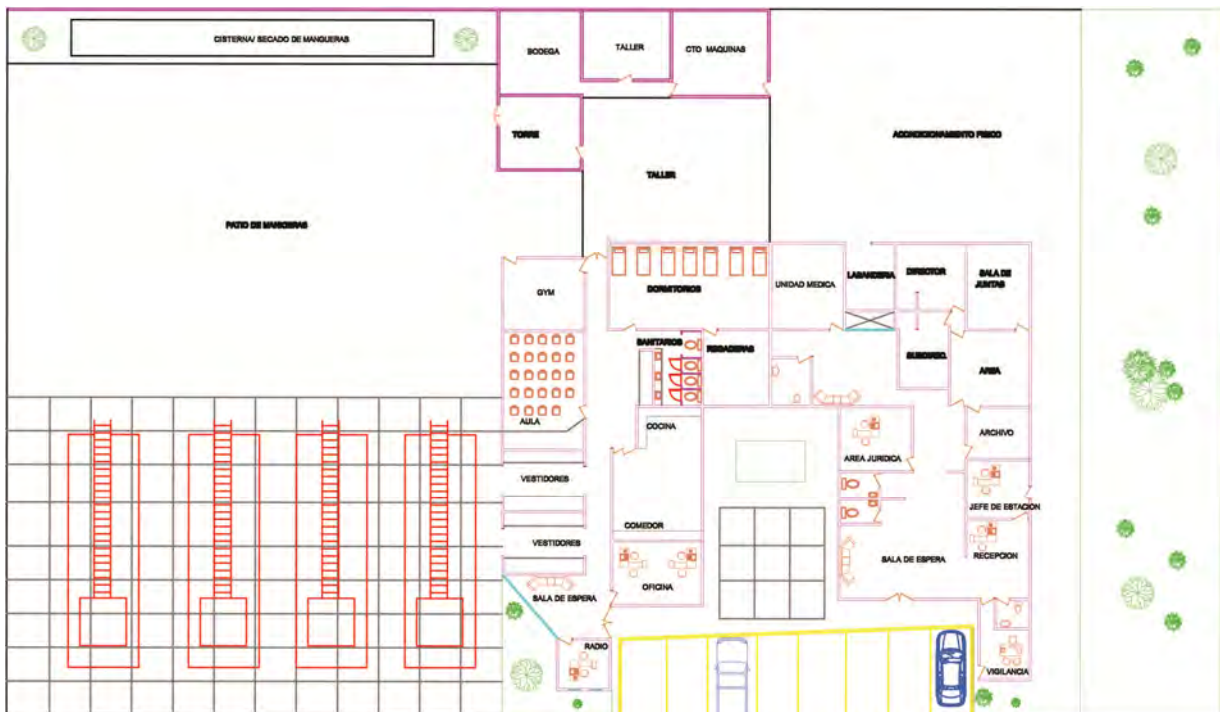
PLANTA ARQUITECTONICA BAJA, ESTACIÓN DE BOMBEROS ZAVALETA, PUEBLA, MEXICO. (2008)
